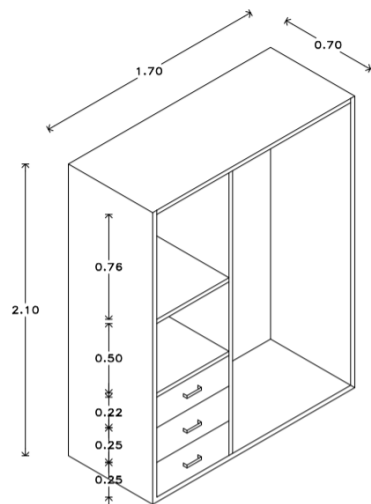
Detalles de carpintería de puertas y closets. Plano de elaboración propia, 2017. Plano CP, véase pág. 157.
